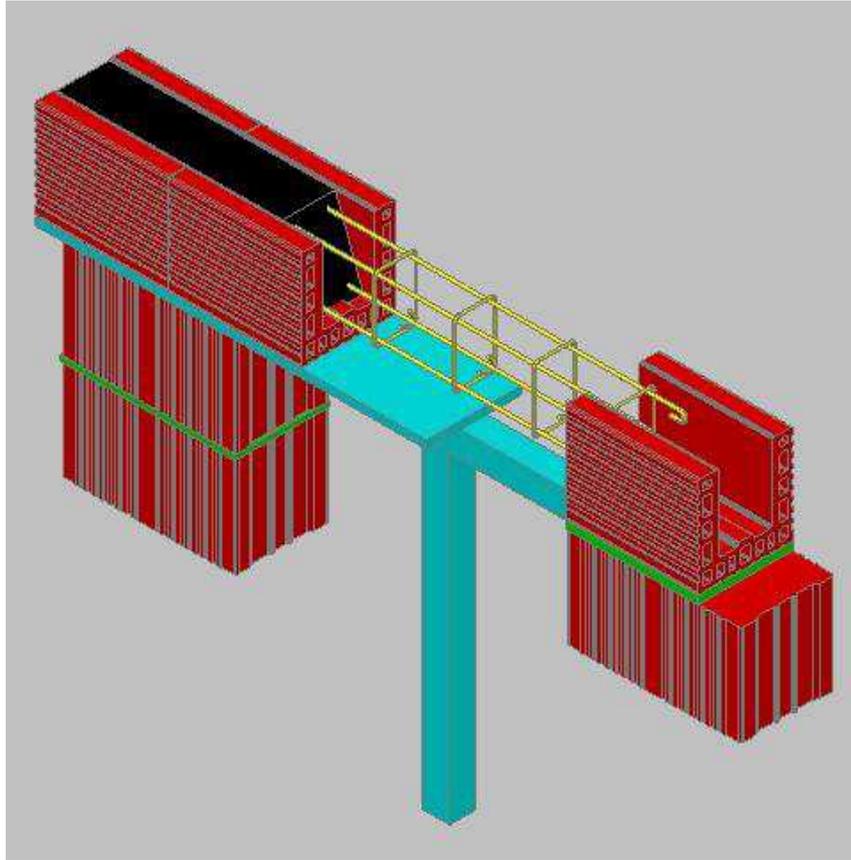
Detalle de viga de hormigón armado (BIBLIOCAD, 2011)
